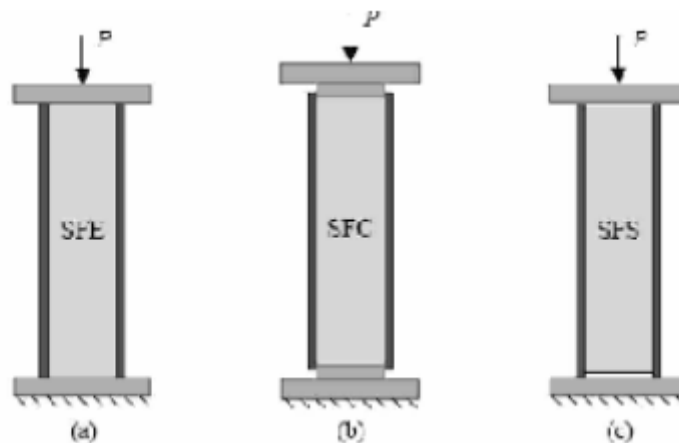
Charge appliquée : (a) la section entière, (b) la section béton, et (c) section acier[26].
